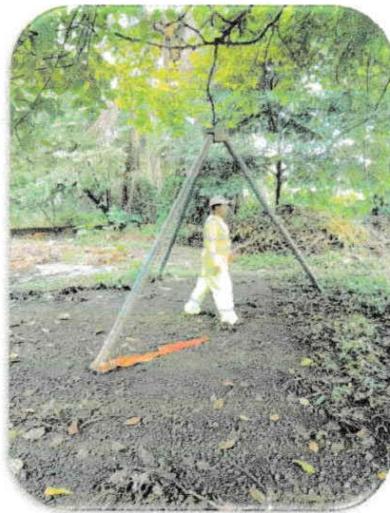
Excavación del hoyo 3. Galeras y Locales Comerciales, 2,023.
